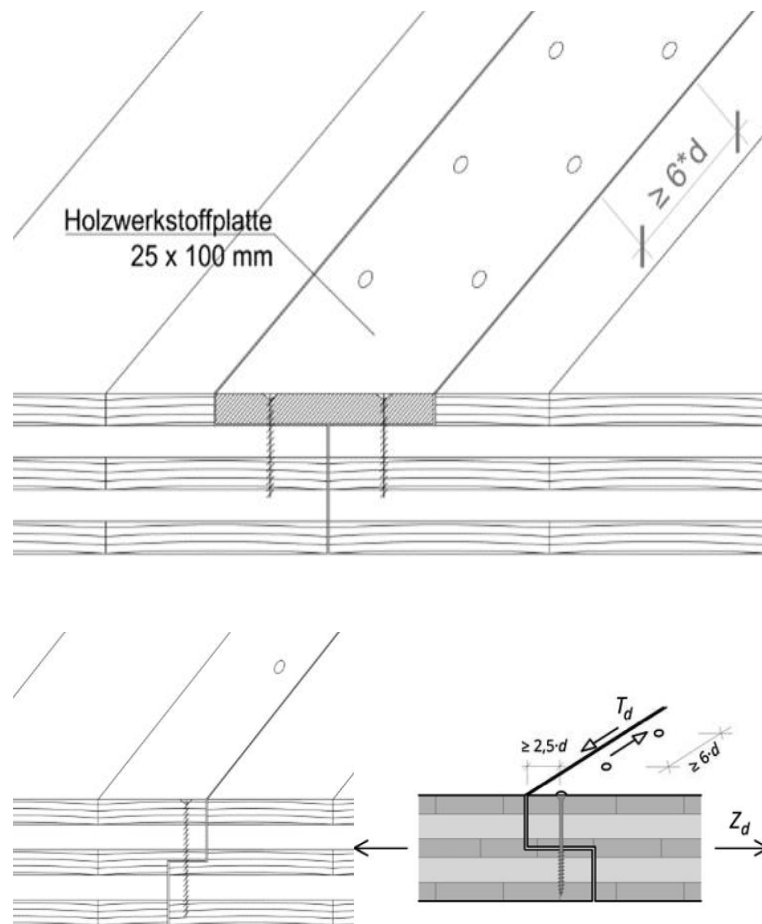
Stoßausbildung mit eingelassener Decklage bzw. als Stufenfalz im Brettsperrelement¹³³
